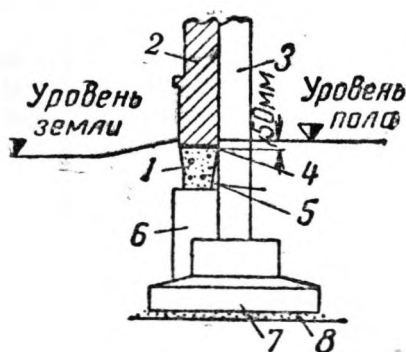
Сборный фундамент под наружную колонну промышленного здания
